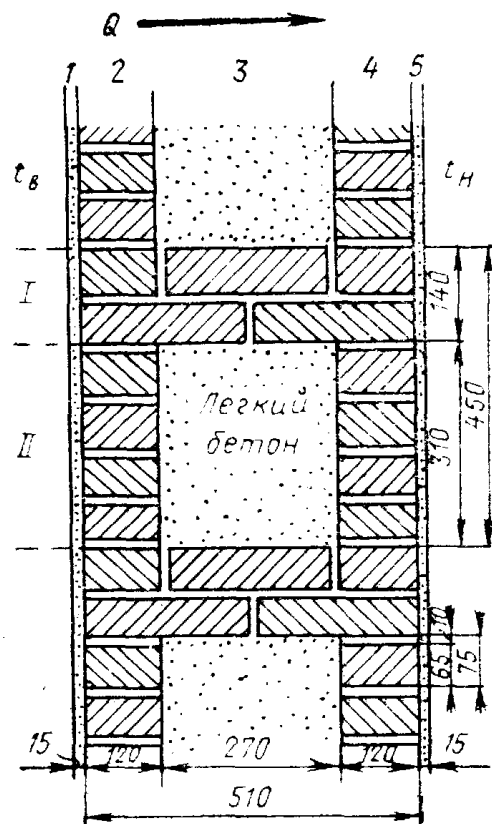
Вертикальный разрез кирпичной стены комбинированной кладки
